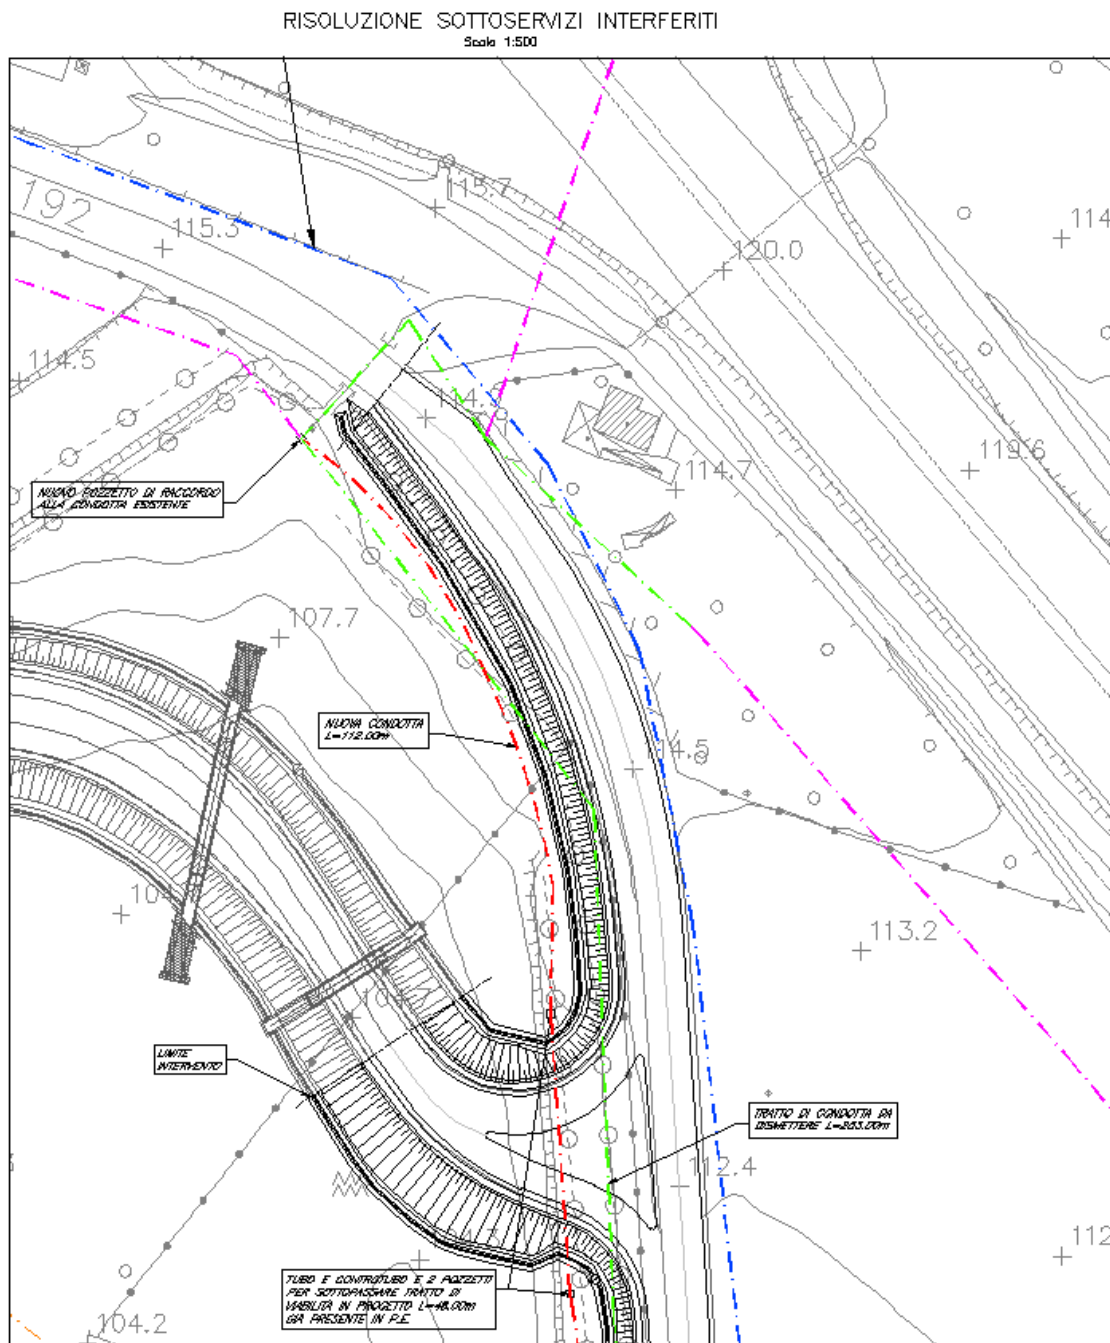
Planimetria risoluzione sottoservizi – tratto nord
